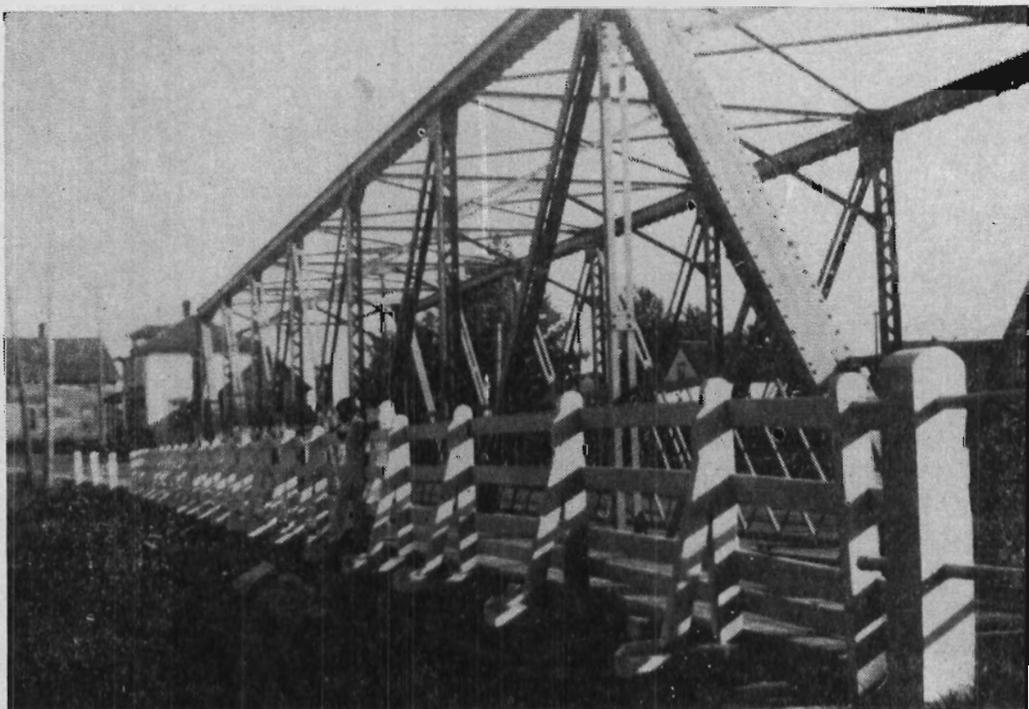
PHOTO PRISE AVANT LA CONSTRUCTION DU PONT DE FER.
